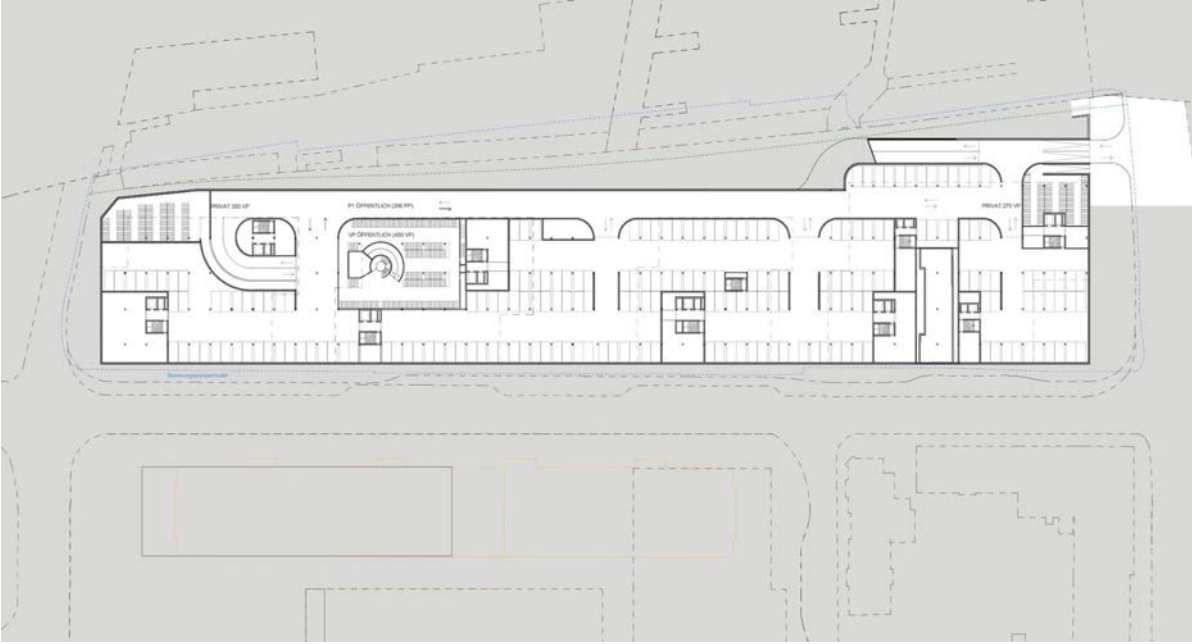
Grundriss SBB-Unterführung Gubelstrasse
